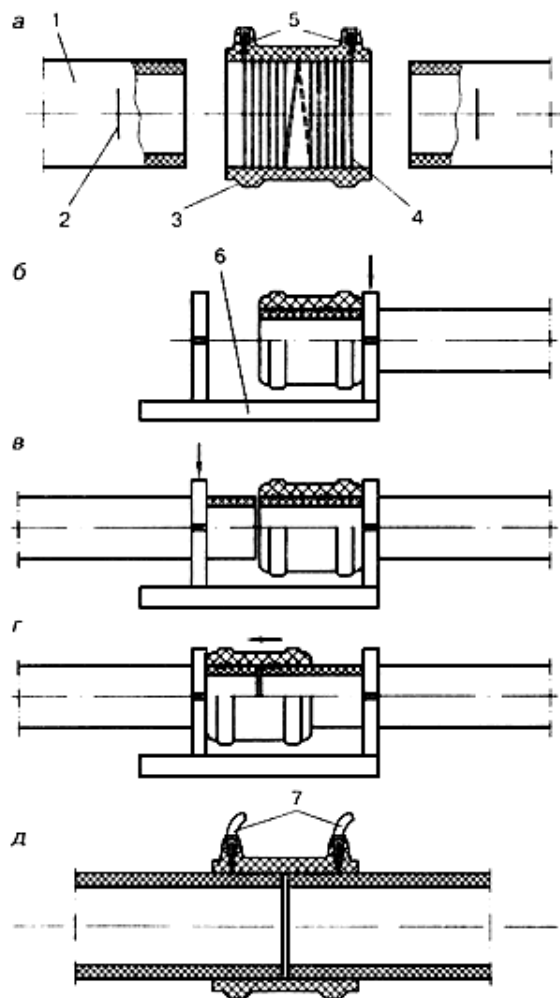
Схема соединения труб муфтой с закладным нагревателем:
